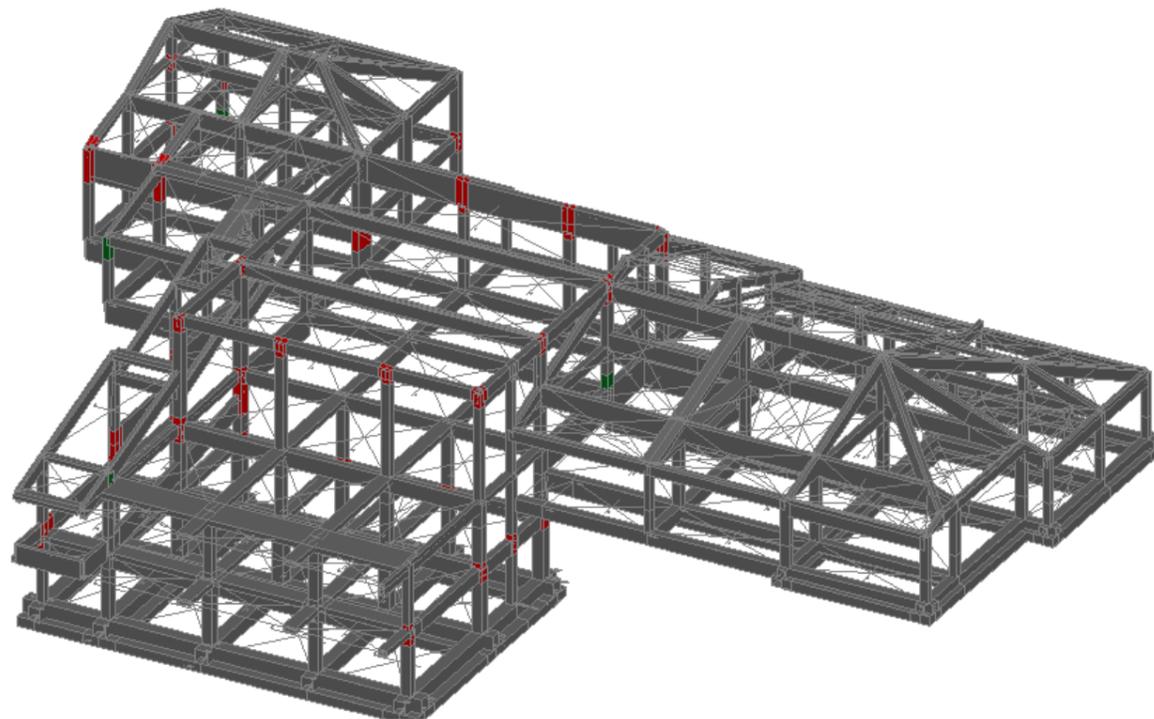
Vista assometrica Edificio "A" con individuazione aree d'intervento
